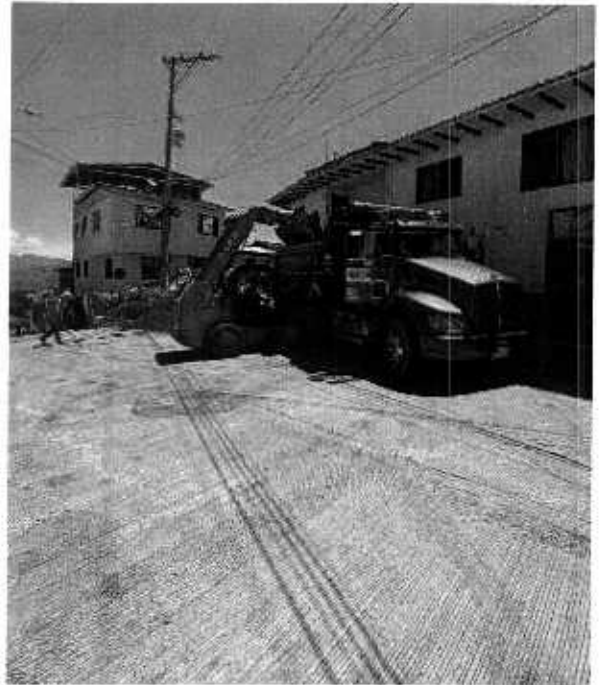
Empalme a recámara existente Cra 4 Foto N° 40: Empalme a recámara existente Cra 4
